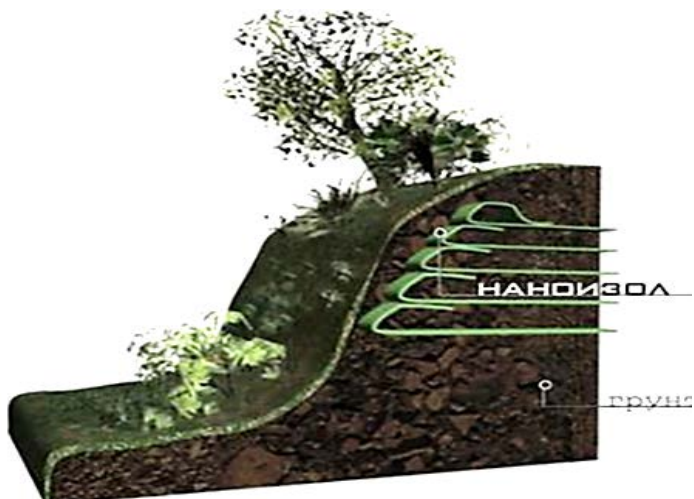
Схема устройства подпорной стенки из армированного наноизолом грунта
